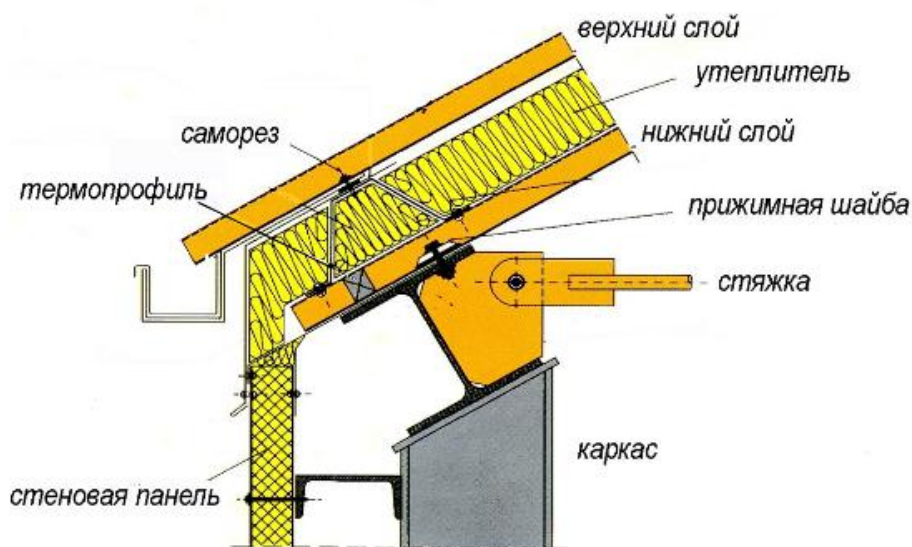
Вариант решения узла крепления двухслойного арочного покрытия
